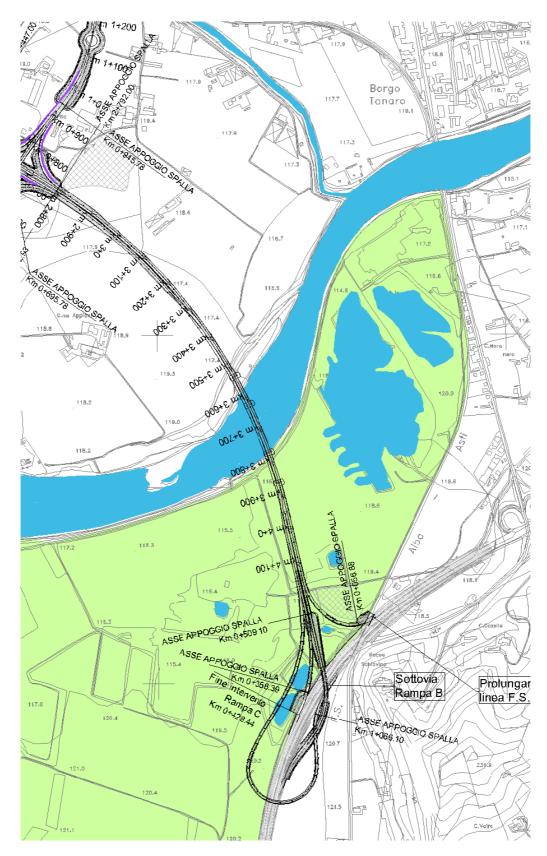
C - Sovrapposizione della planimetria di Progetto sul Perimetro del SIC
